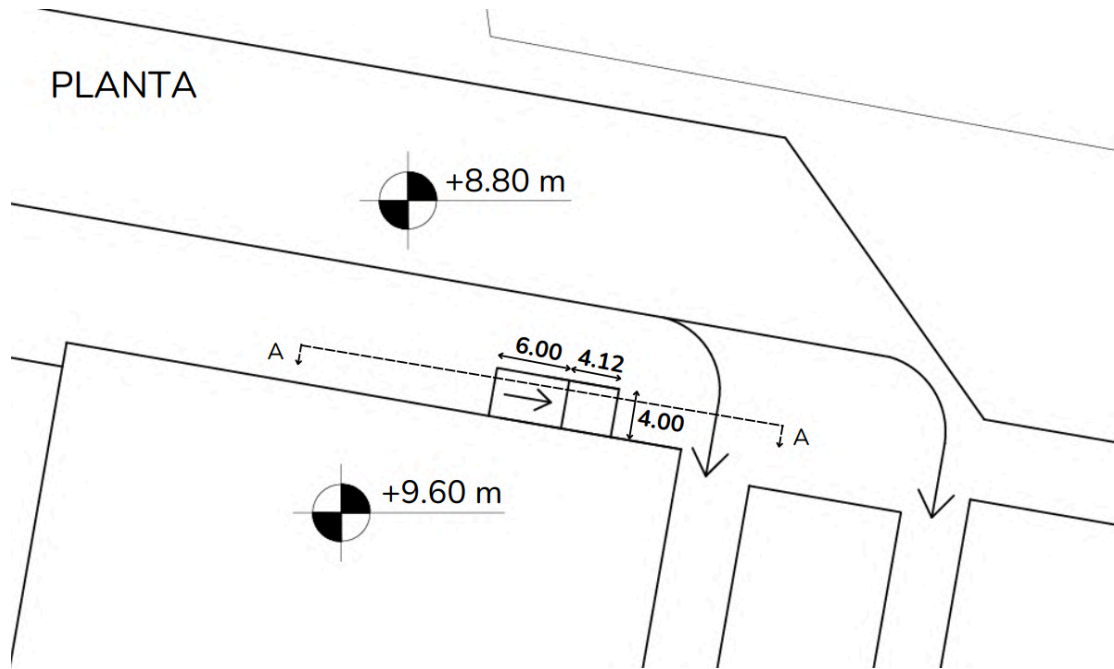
Detalle de rampa en planta. Fuente: elaboración propia.
